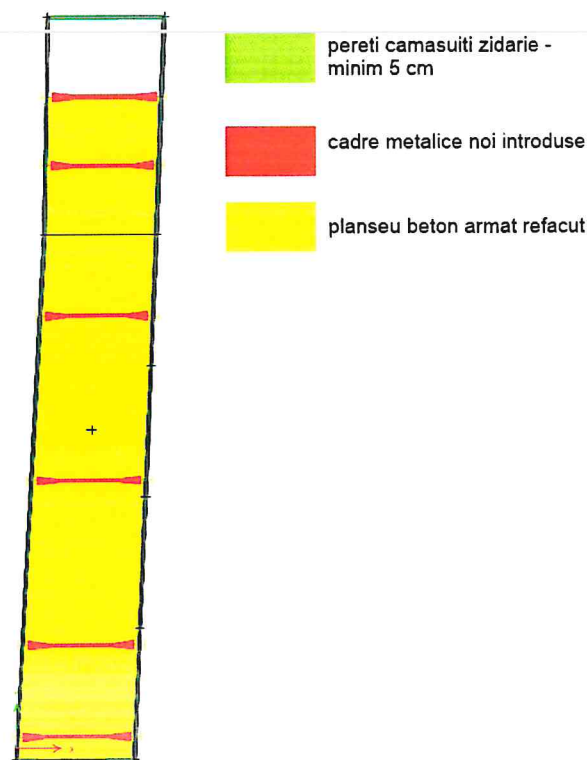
Identificare elemente nou introduse din beton armat planșeu peste parter
